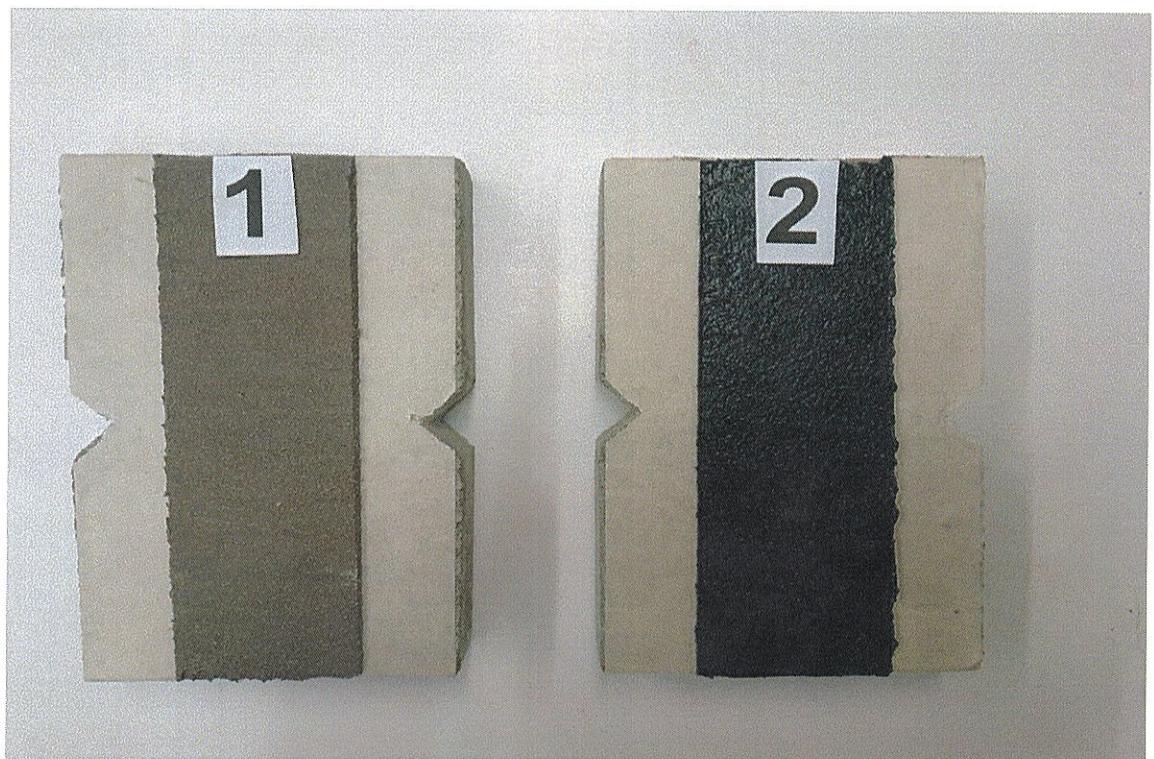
Внешний вид бетонных образцов с системами покрытий на основе материалов Remmers для испытаний на трещиностойкость
